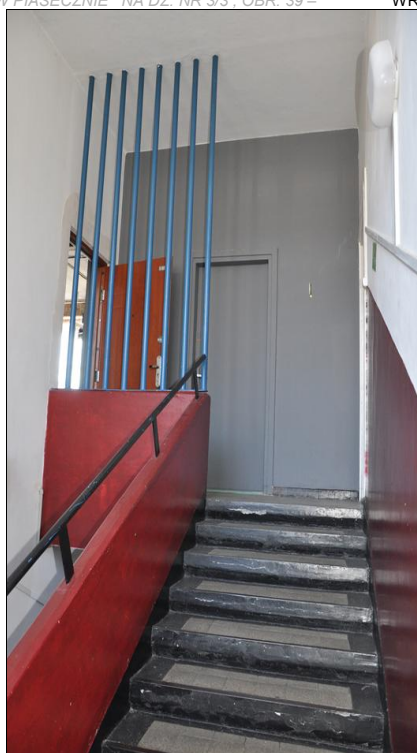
Widok wnętrza biura kolejki PGTKW.
